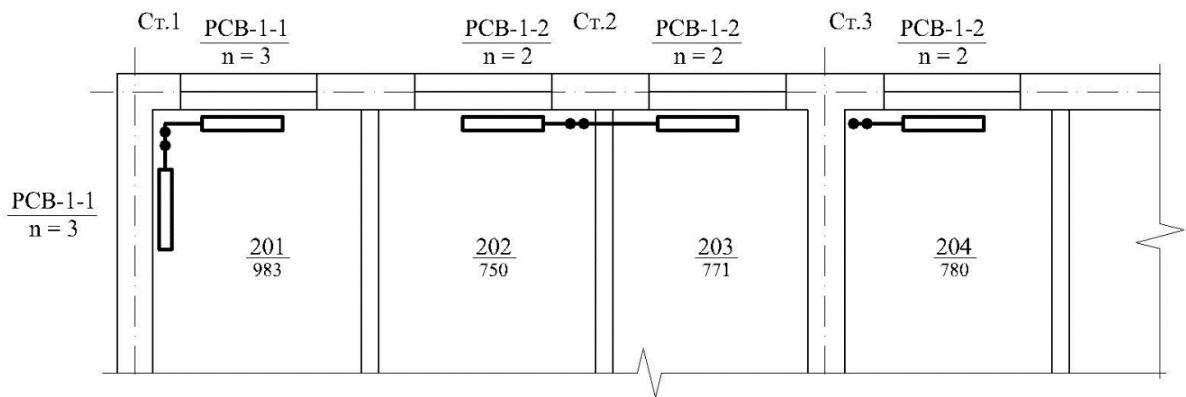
Вариант размещения отопительного оборудования на поэтажных планах здания
